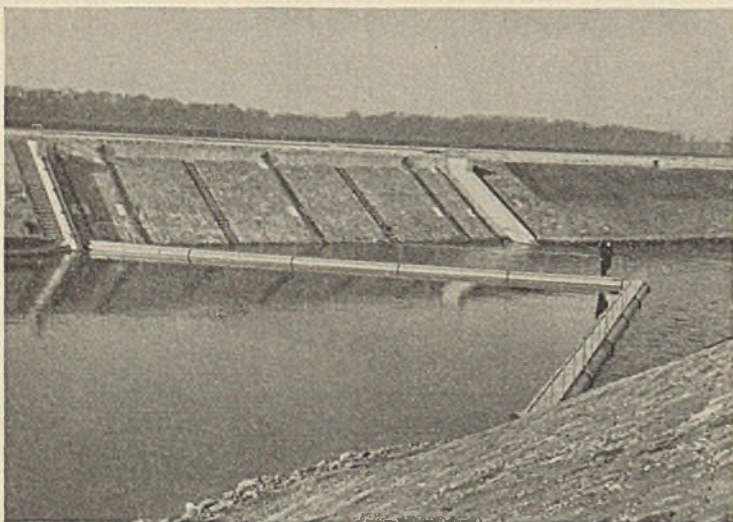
Schwimmkörper in Verschlusslage. Blick nach dem Stichkanal.
